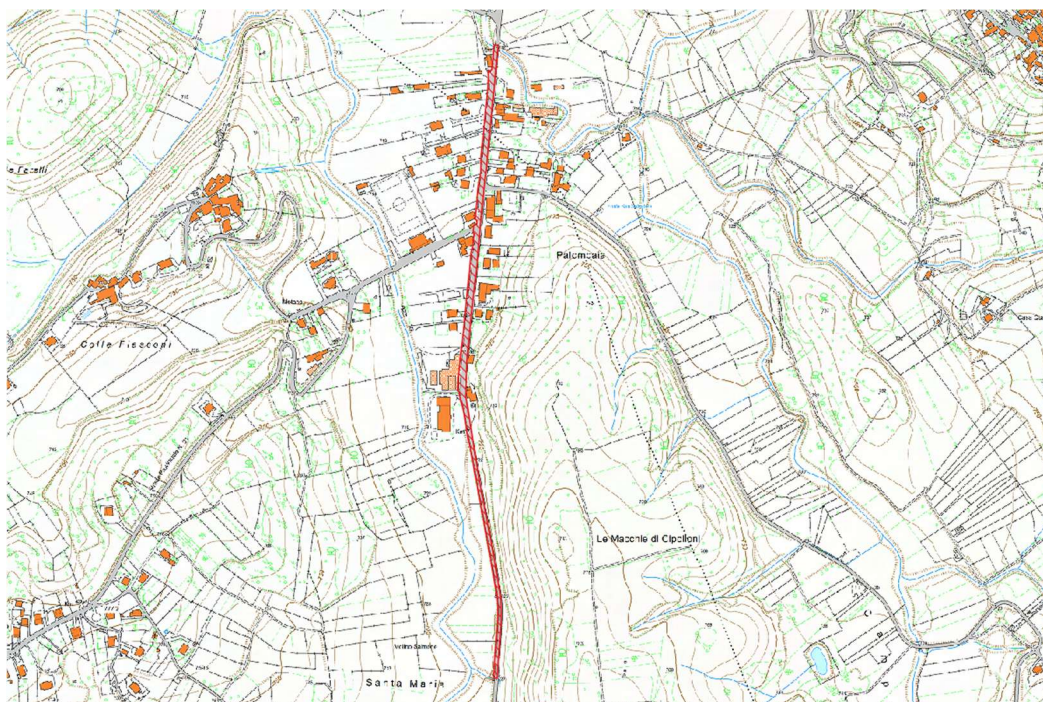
Piattaforma stradale oggetto dell'intervento.
